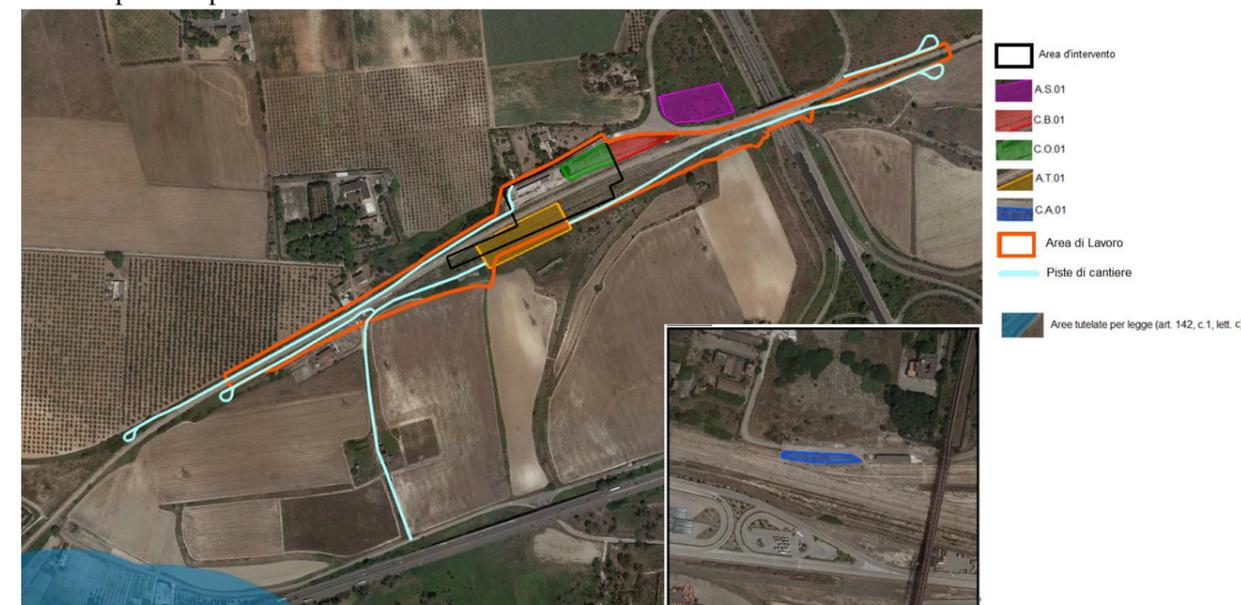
Localizzazione dell'area d'intervento e delle aree di cantiere rispetto il vincolo
